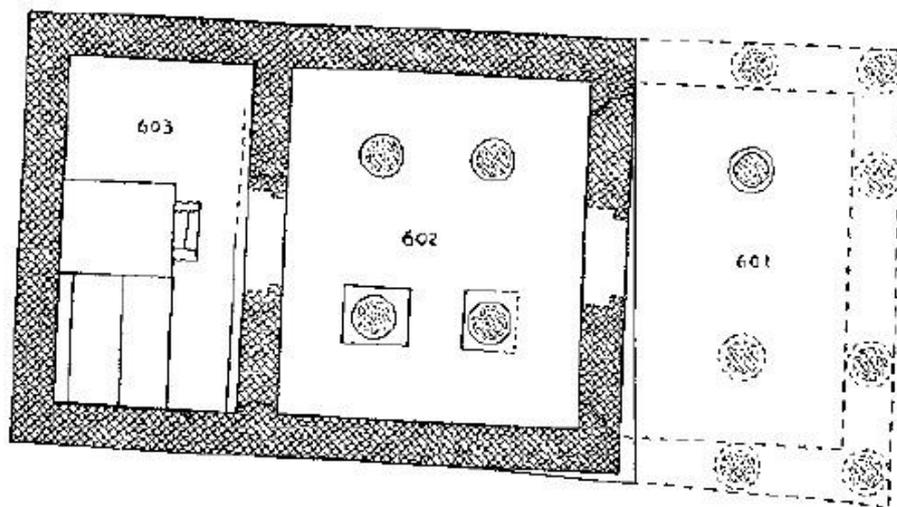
Planta del edificio B600 (REISNER 1918: pl. X).
